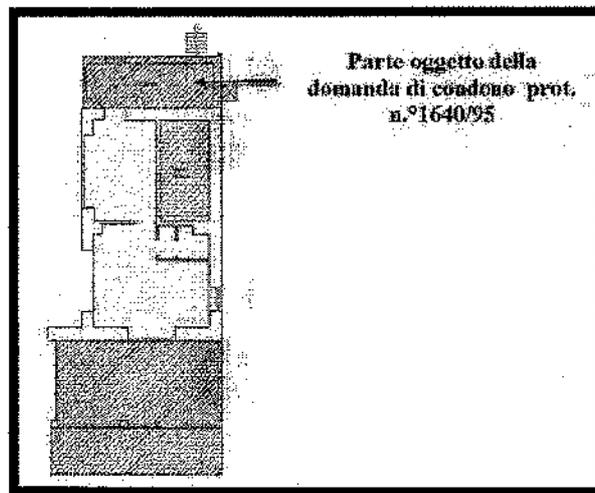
Pianta piano terra (sub 2) – Rilievo eseguito in occasione dei sopralluoghi
